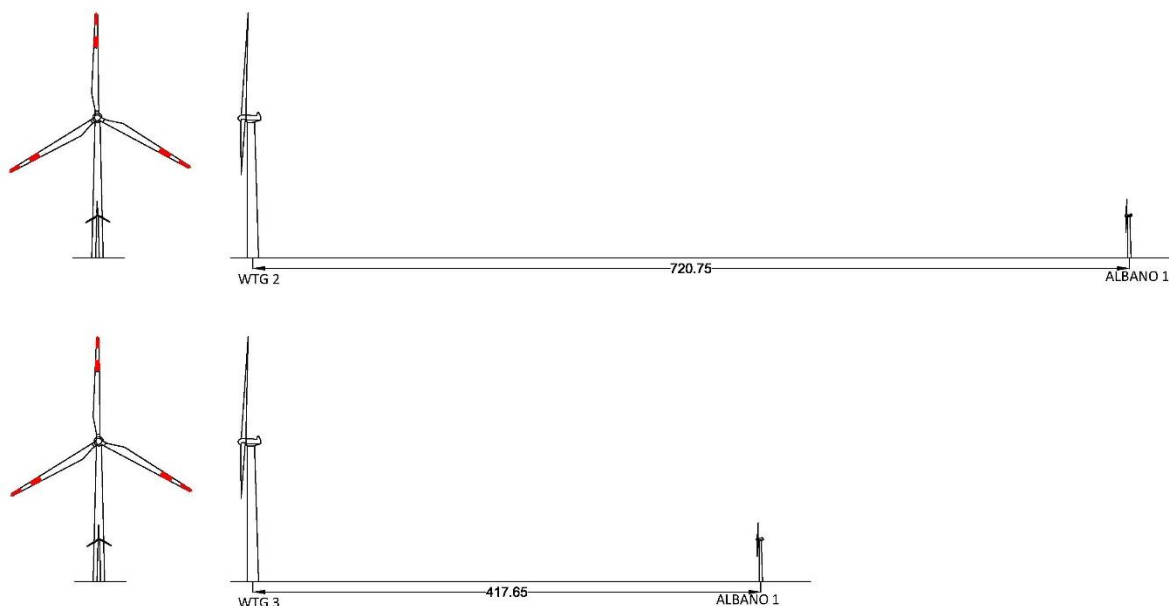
Prospetto frontale (sx) e laterale (dx)
